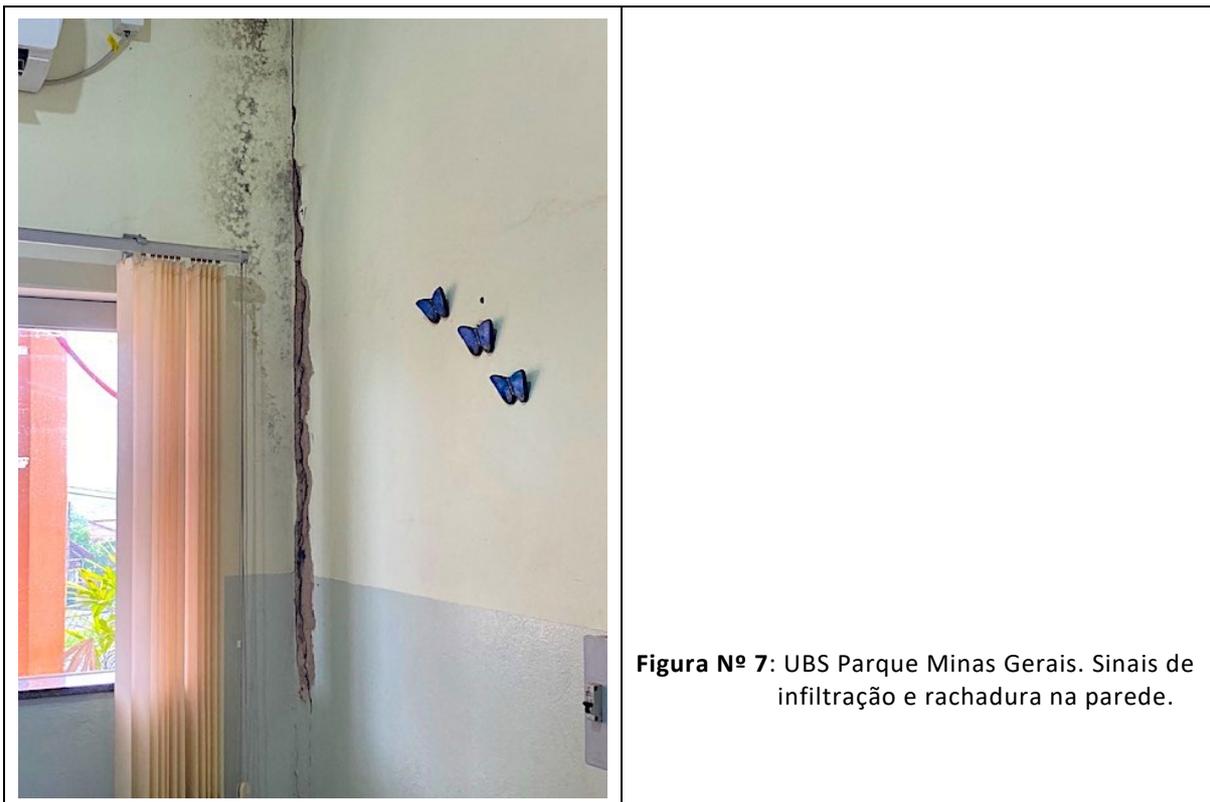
UBS Parque Minas Gerais. Sinais de infiltração e rachadura na parede.
